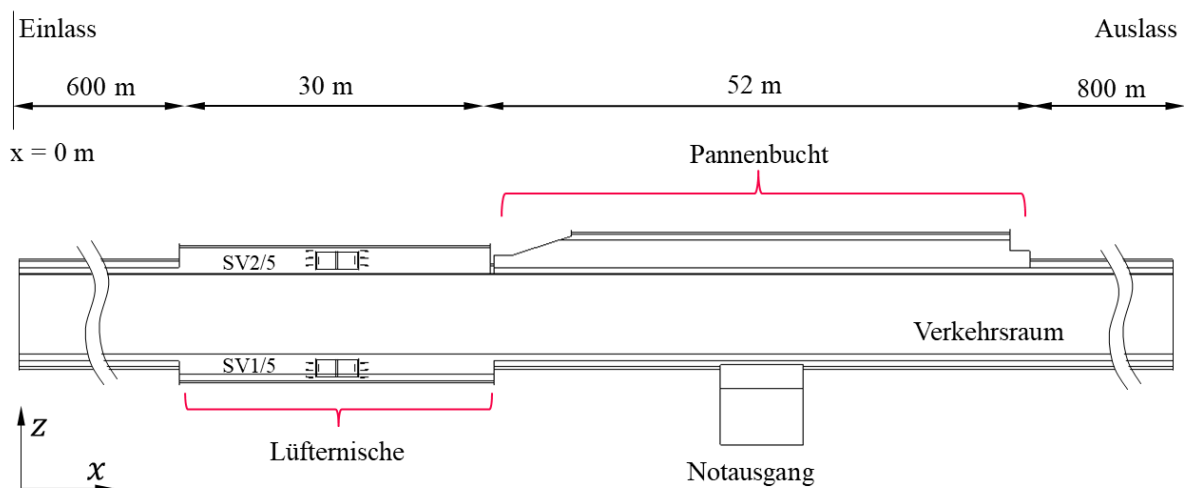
Grundriss des Berechnungsgebietes – Bosrucktunnel [Saurwein, 2014]
